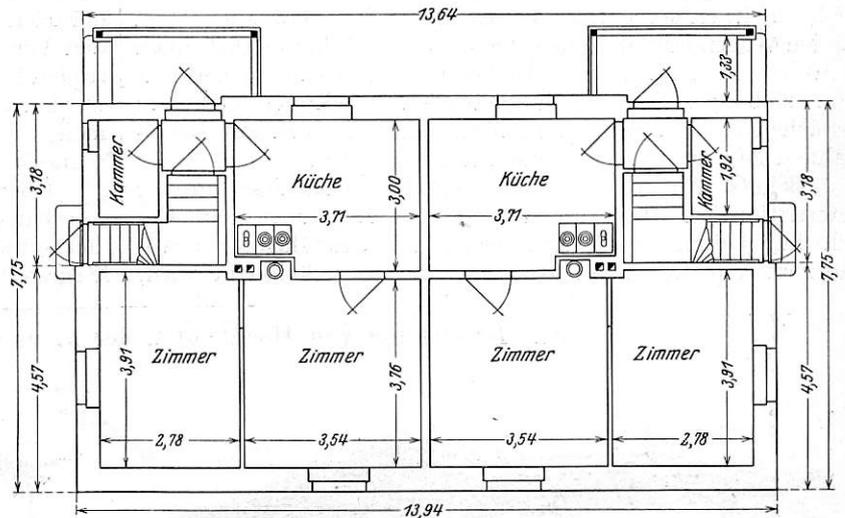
Grundriß des Erdgeschosses eines Arbeiterwohnhauses für zwei Familien.
